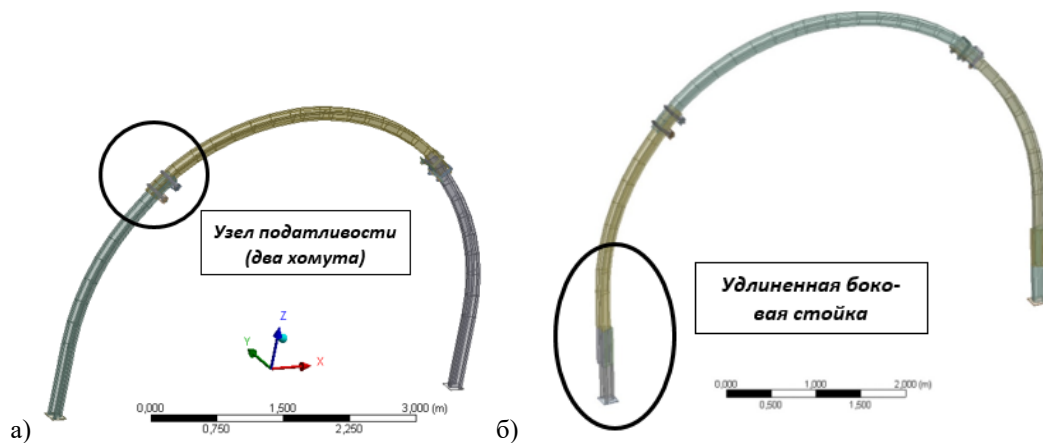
Общий вид параметрической модели крепи из профиля СВП27 стандартной конструкции (а) и с удлинением боковой стойки (б)
